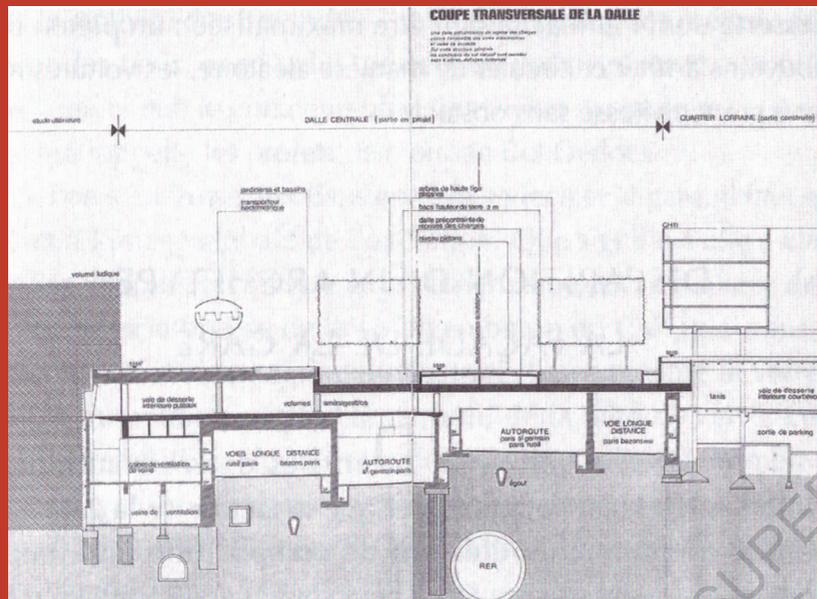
Coupe transversale de la dalle de La Défense, par Dan Kiley and partners, architectes-paysagistes.
